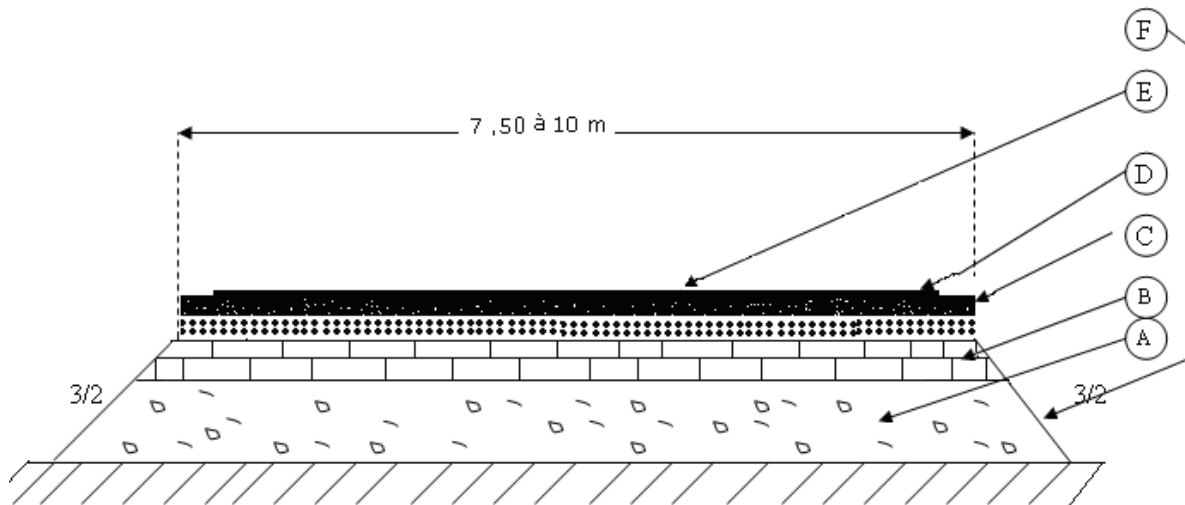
Coupe transversale type d'une chaussée saharienne
